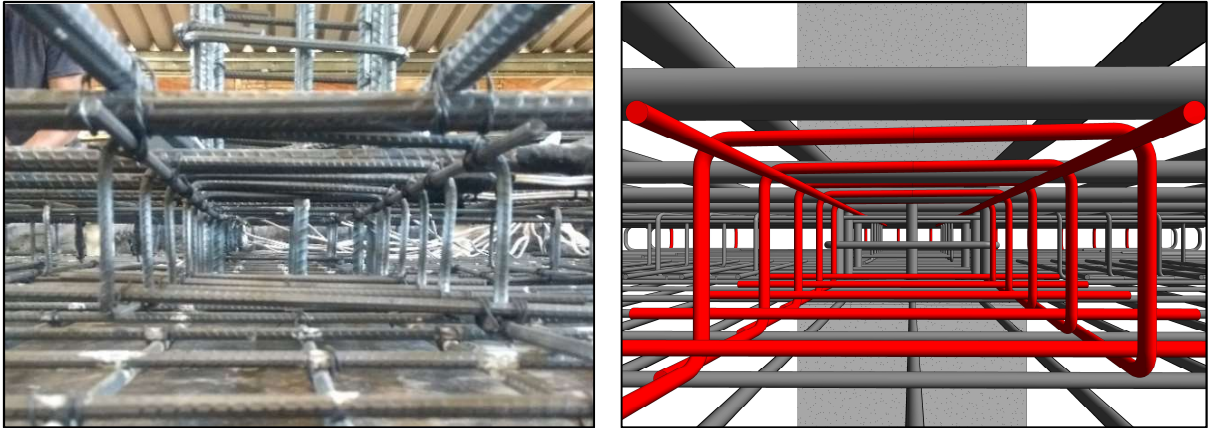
Detalhe do estribo “caranguejo” na laje CNA.
